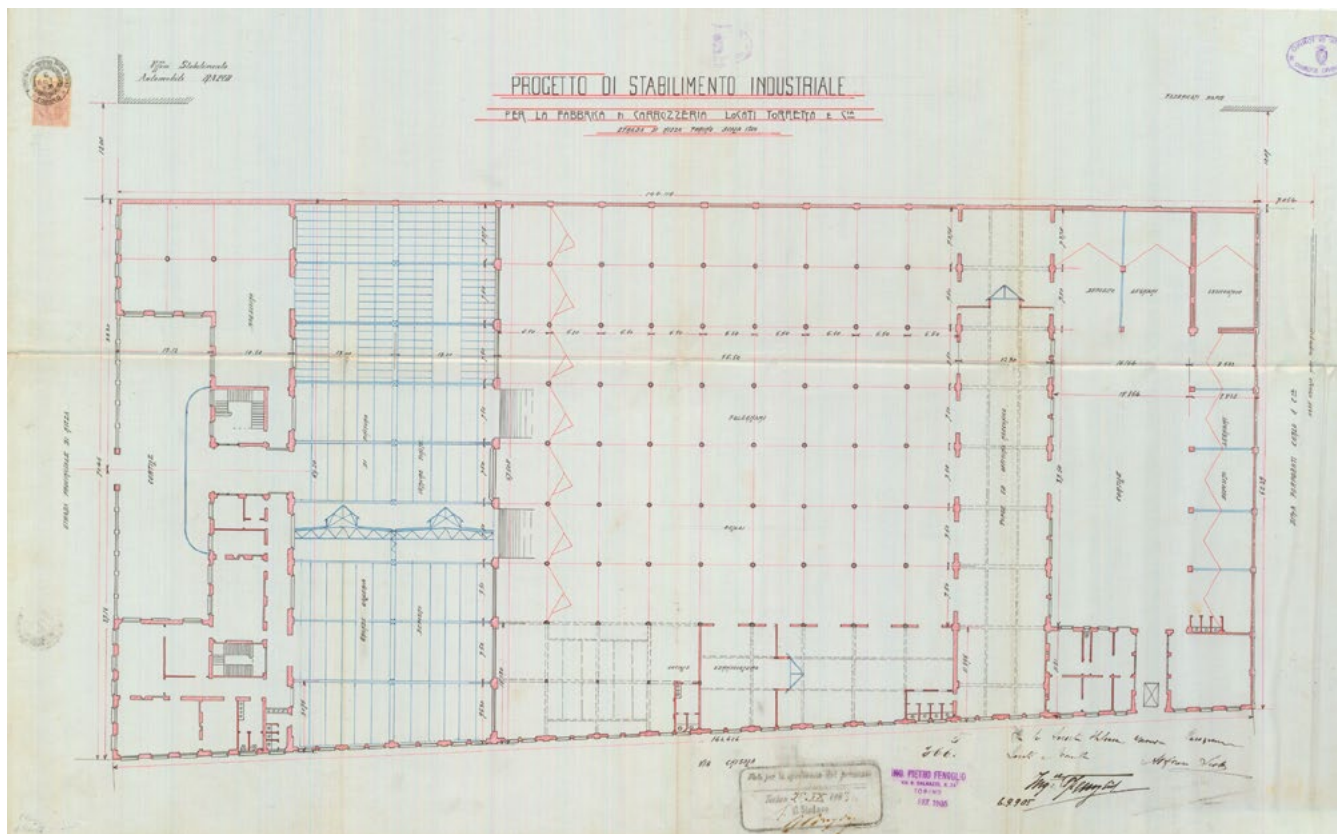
Pietro Fenoglio, planimetria dello stabilimento Locati-Torretta (ASCT, Progetti Edilizi, 1905, n. 366, tavola 2).
